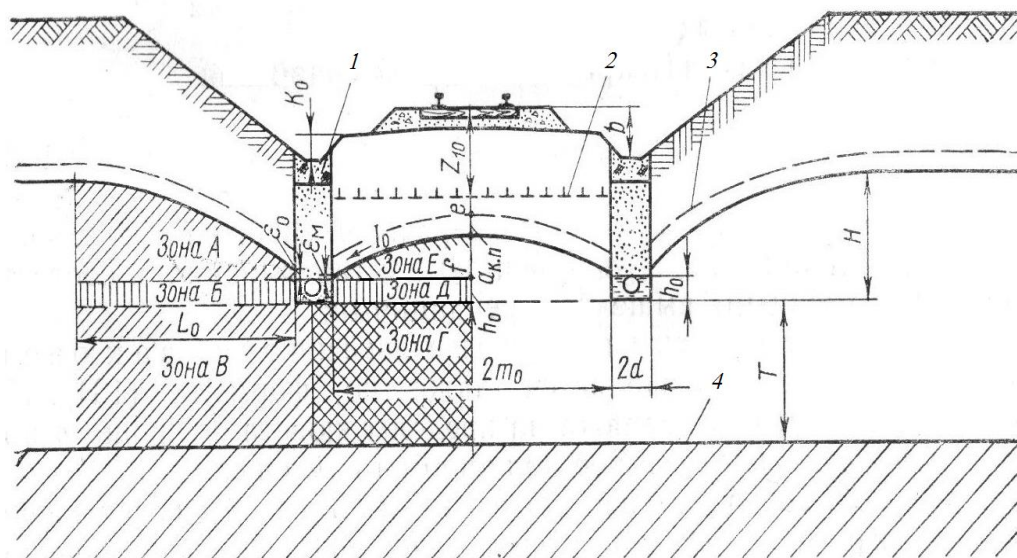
Расчетная схема к проектированию подкюветного двустороннего несовершенного дренажа: 1 – глинобетон; 2 – граница промерзания; 3 – граница зоны капиллярного поднятия; 4 – кровля водоупора.
